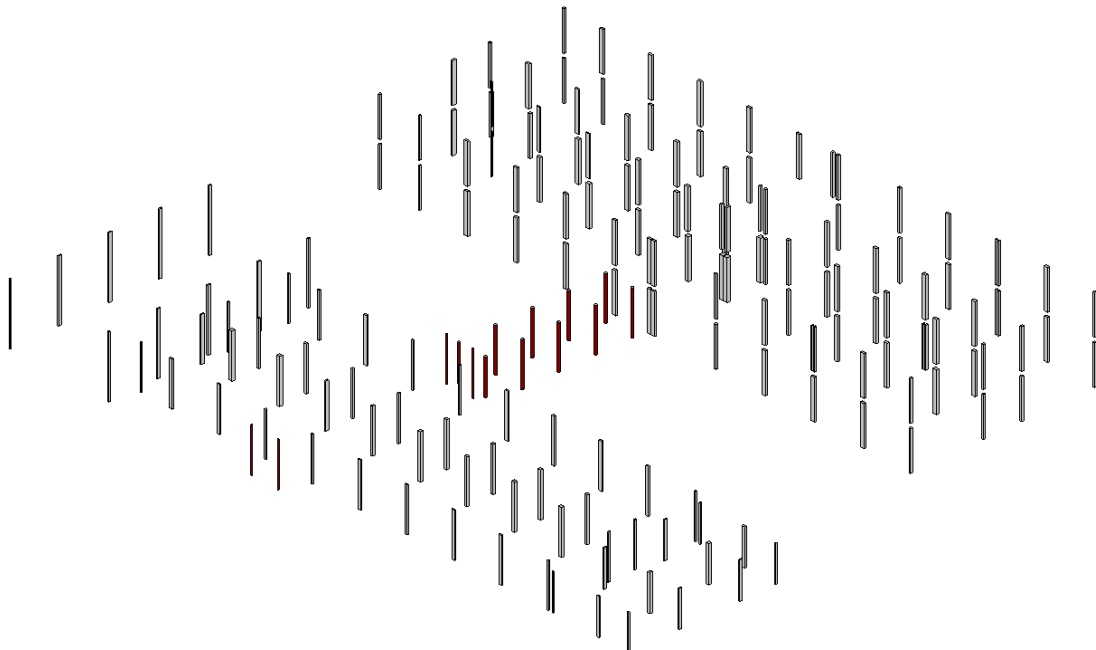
Vista 3D de los pilares en el modelo arquitectónico
